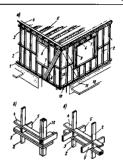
Конструкции наркасного дома оплатформенным сопряжением стоек:
